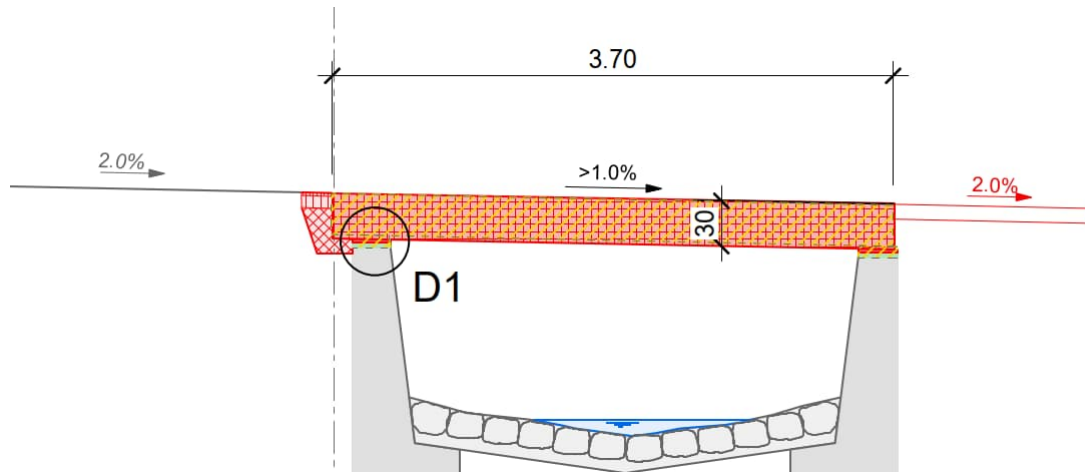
Ersatz Brückenplatte Zufahrt Parz. 106 und 676 (vgl. Plan Nr. 2-1537.1 / 05)
